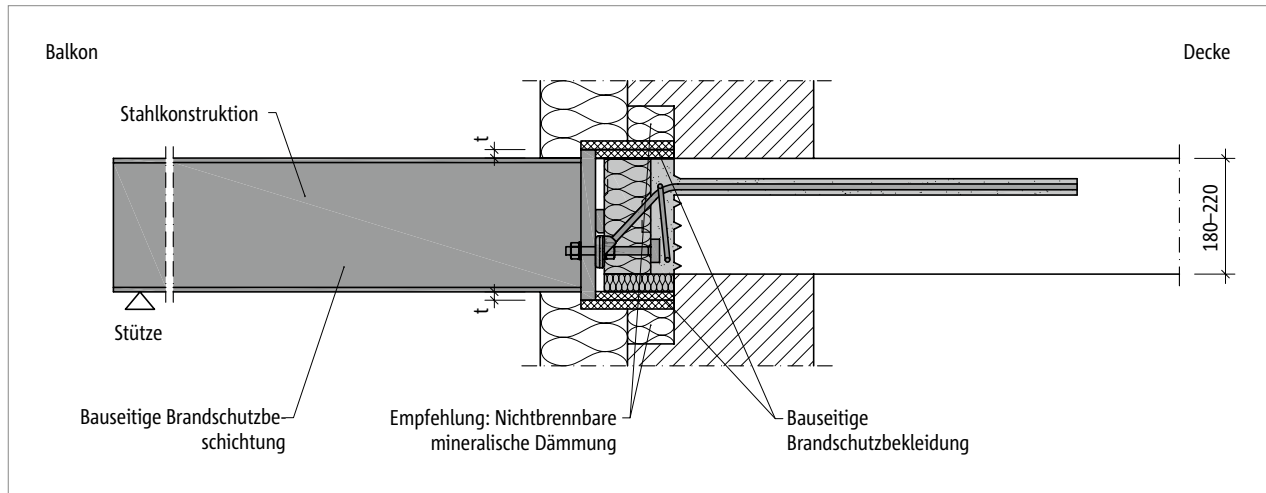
Schöck Isokorb® RT Typ SQ: Bauseitige Brandschutzbekleidung RT Typ SQ und brandschutzbeschichtete Stahlkonstruktion; Schnitt
